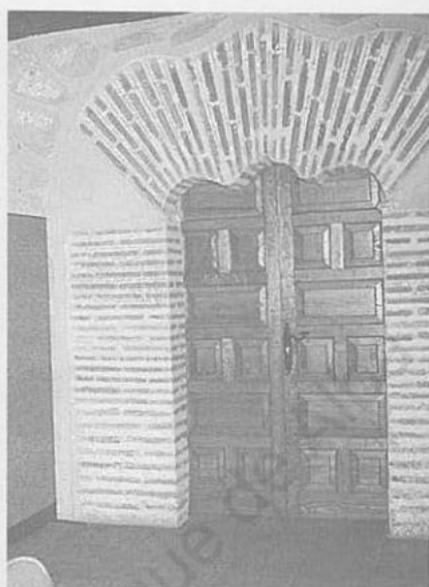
Claustro del Noviciado. Panda este. Segundo piso. Sala de investigadores. Muro sur-lado norte.
